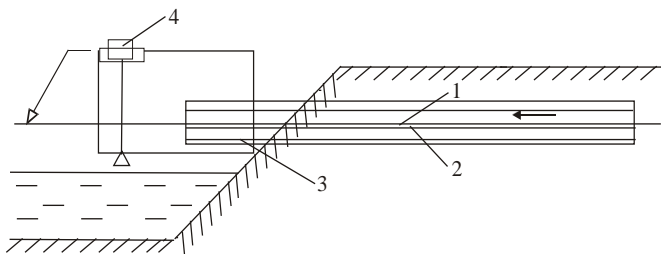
Схема водомерного устройства для устья закрытой дрены:
